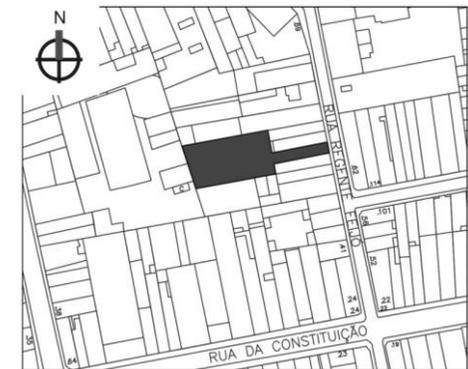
Implantação. Fonte: acervo LabHab.
